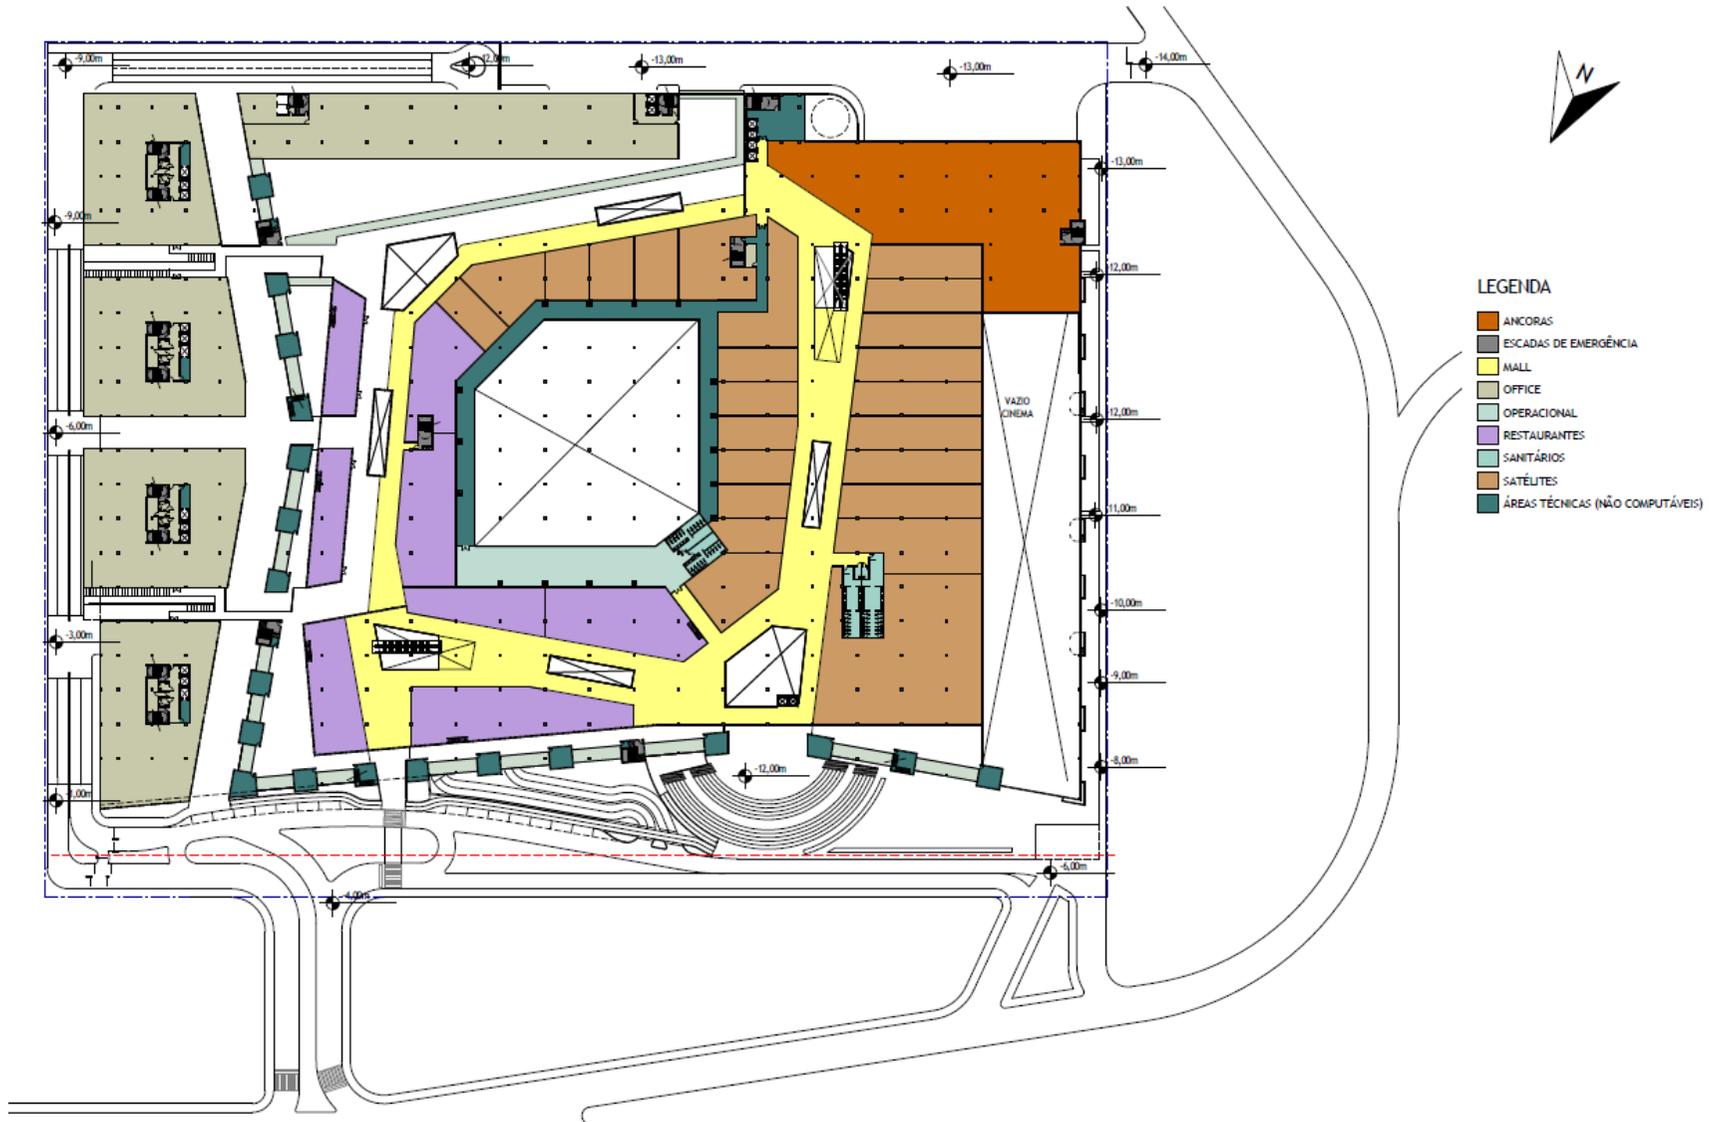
Planta baixa 2Pavimento (L3), Nível 6,00m
